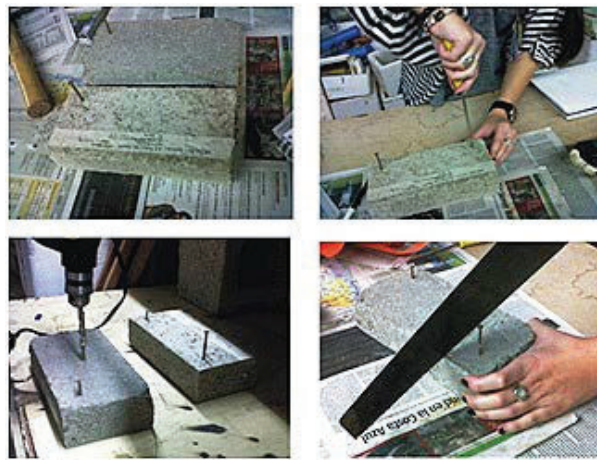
Pruebas de clavado, atornillado, taladrado y serruchado⁶⁵
